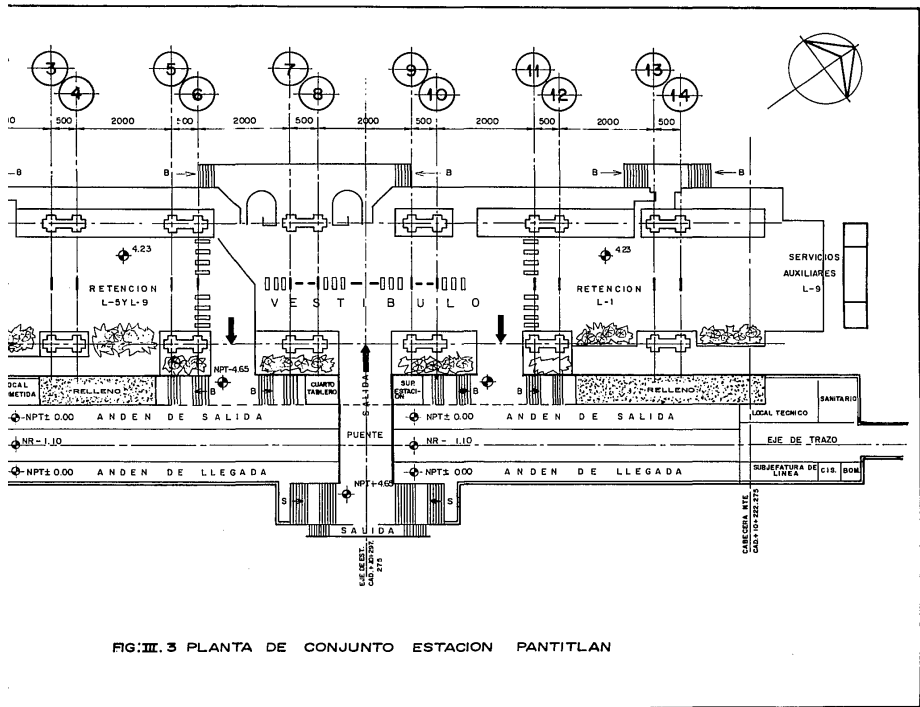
PLANTA DE CONJUNTO ESTACION PANTITLAN
